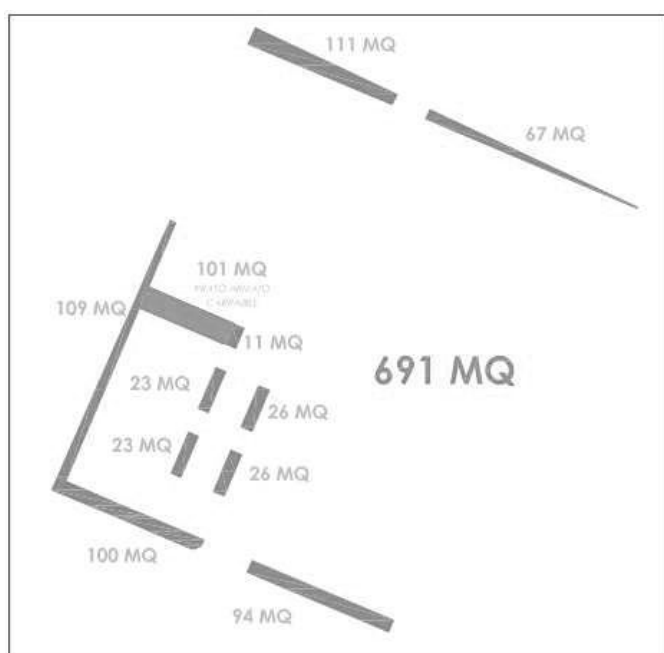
b Planimetria di stato di progetto, per il park nord – evidenziazione delle aree permeabili
